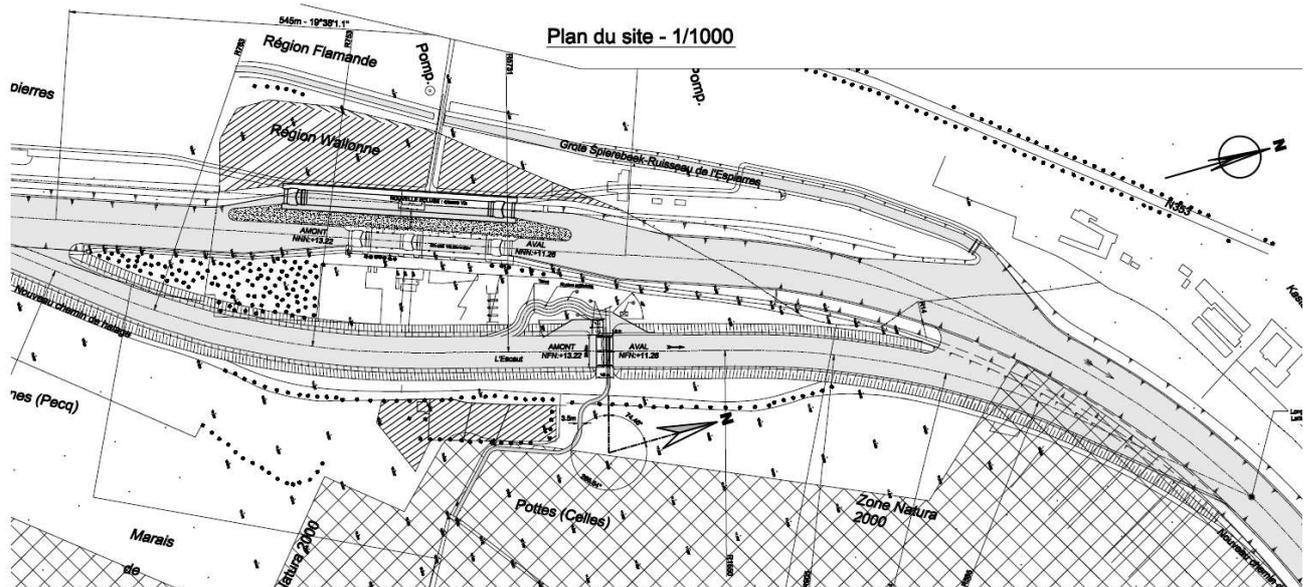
Site du barrage éclusé de Héringnes, situation projetée avec aménagement d'un nouveau barrage (source : SPW)
